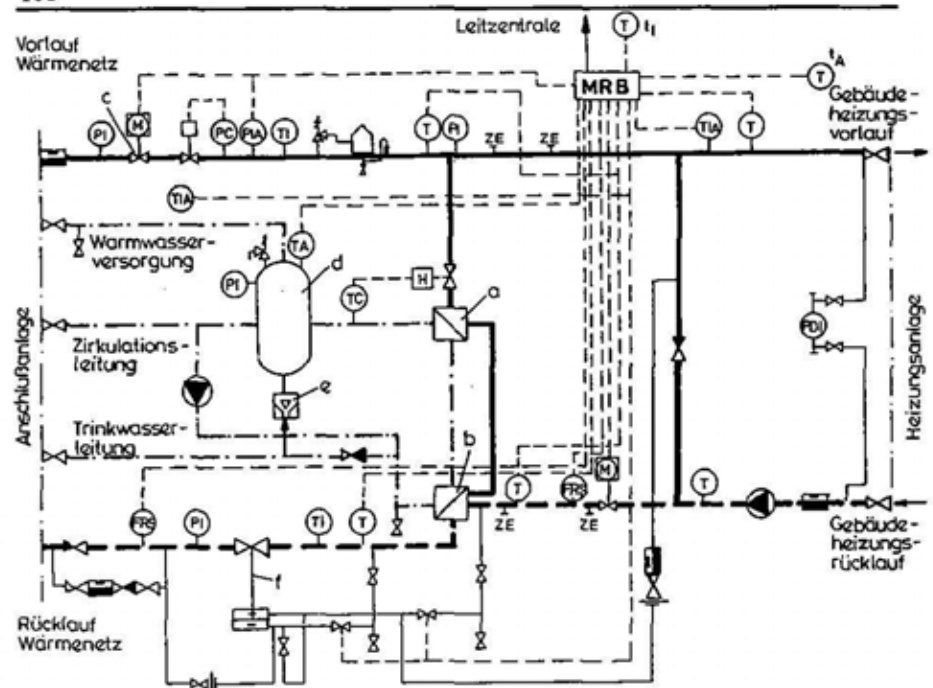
Schaltschema der Hausanschlussstation Typ HA 3 mit Mikrorechnerbaustein (ab 1984)
